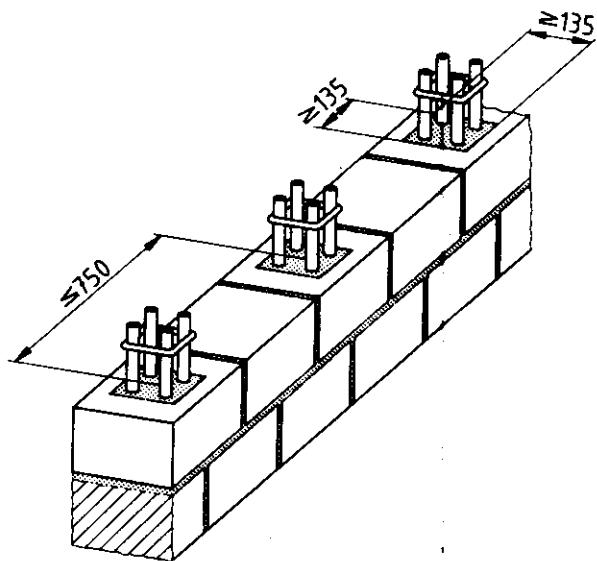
Vertikale Bewehrung in Formsteinen mit großer Aussparung (Prinzipskizze)
